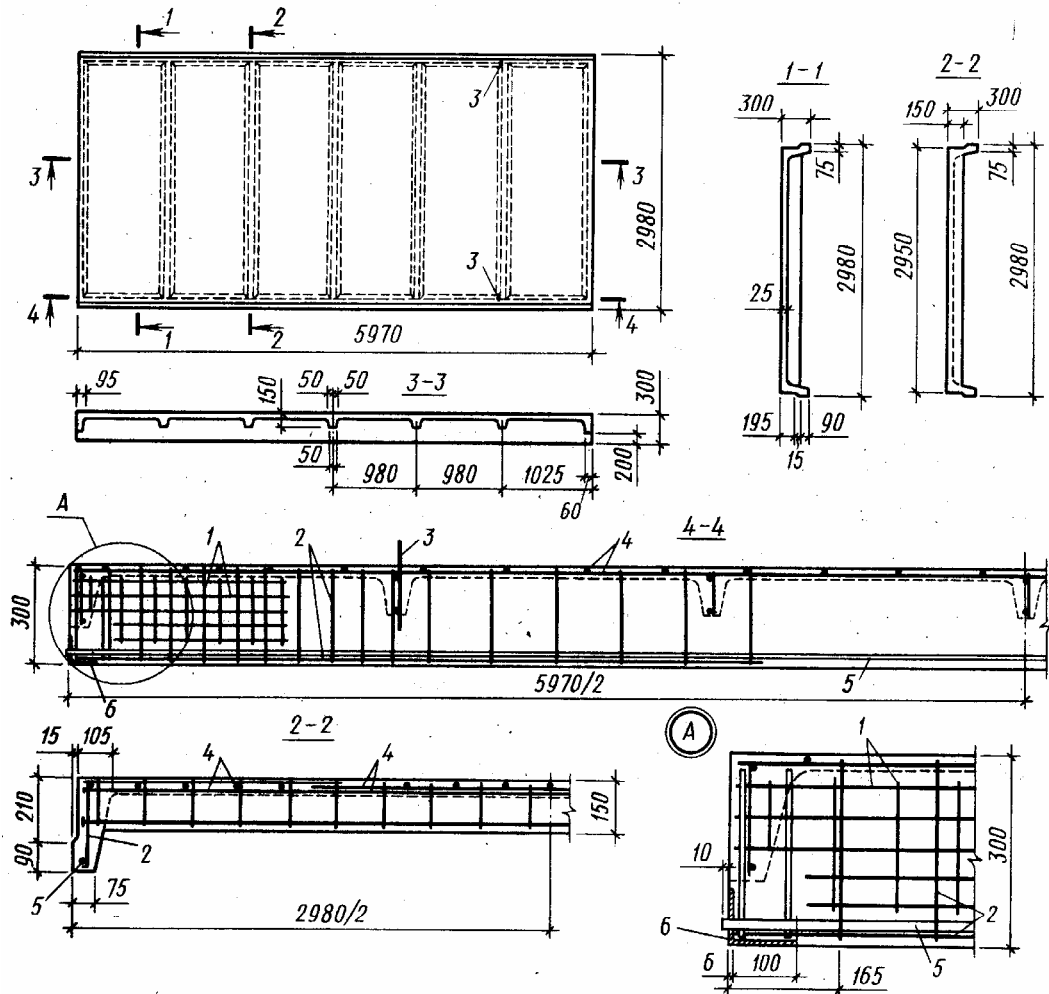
Конструкция железобетонной плиты размером  $3 \times 6$  м
